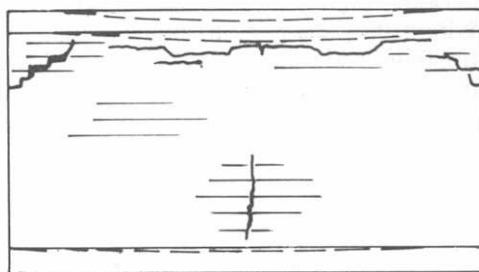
Trincas em parede de vedação: deformação do suporte inferior à deformação da viga superior.
